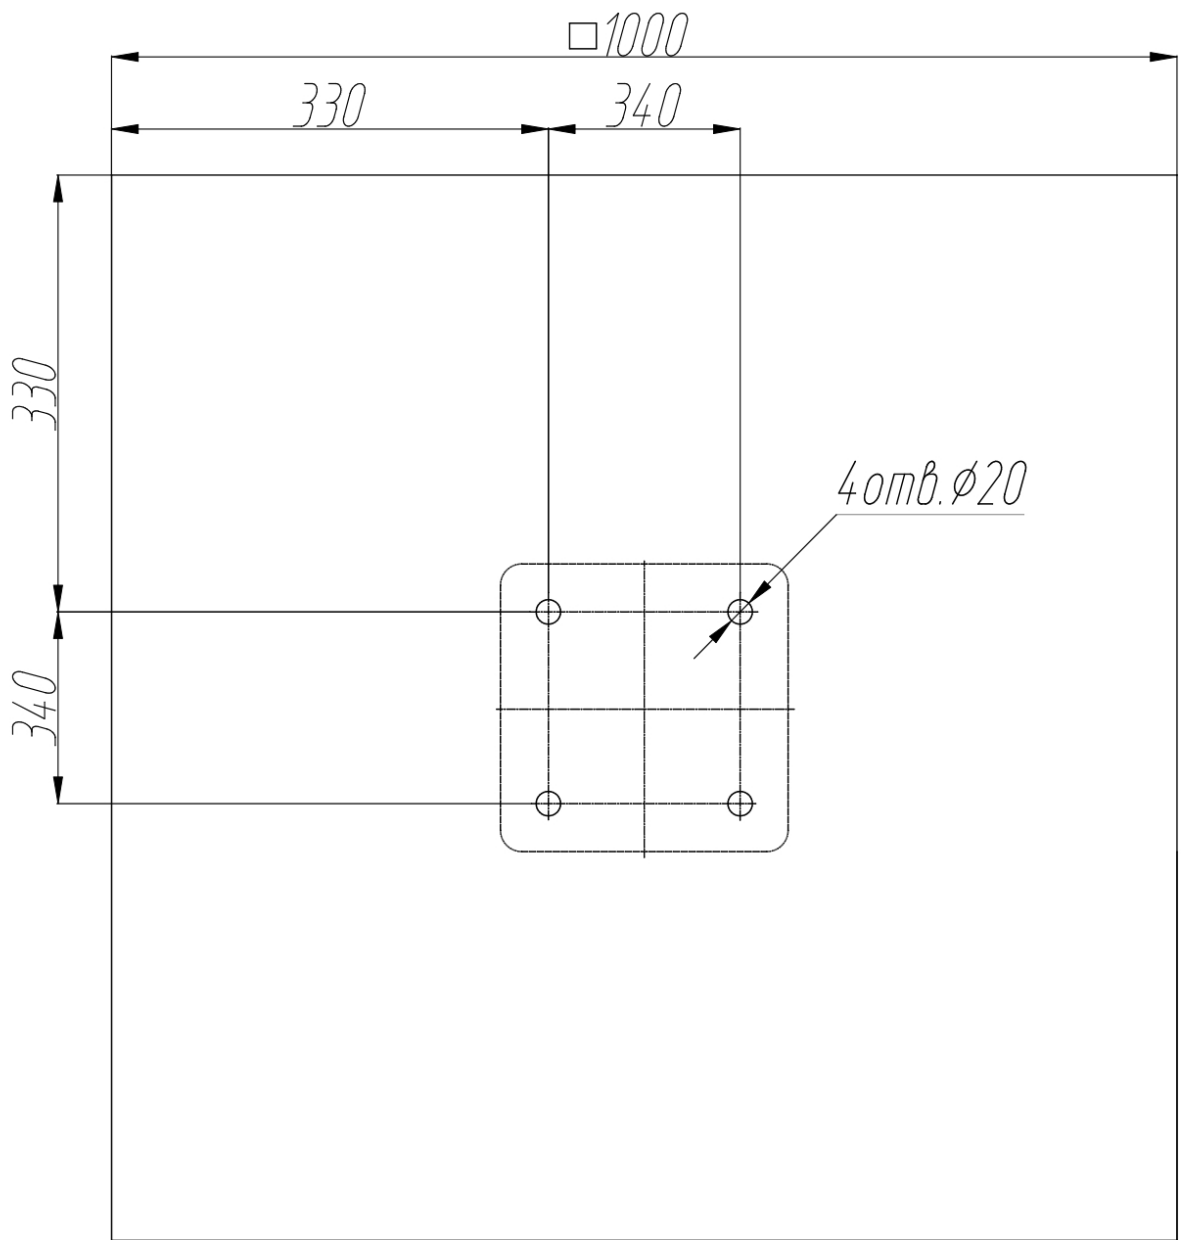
Схема расположения отверстий на фундаменте
